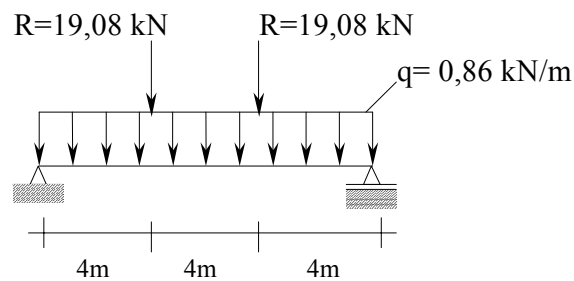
Esquema estrutural da viga V1-Análise estática
